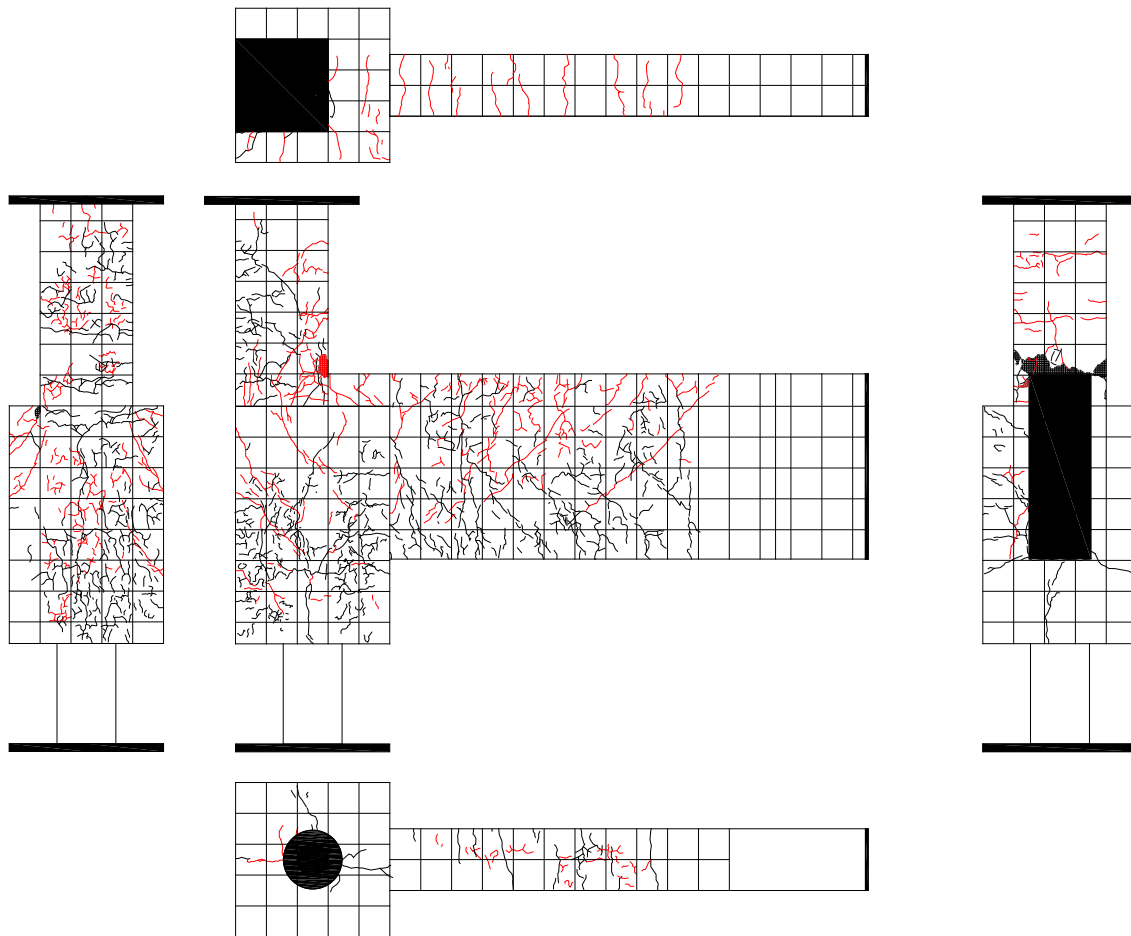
試験体 C-3 ひび割れ状況 (60cycle)
